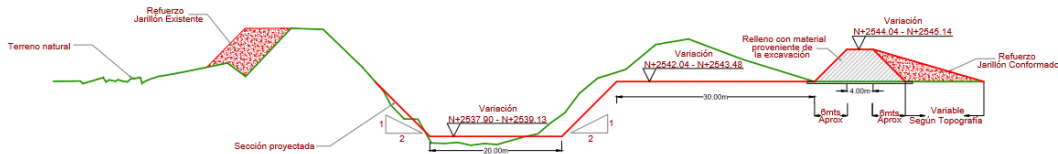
Sección típica 5 de corte transversal Río Juan Amarillo.
